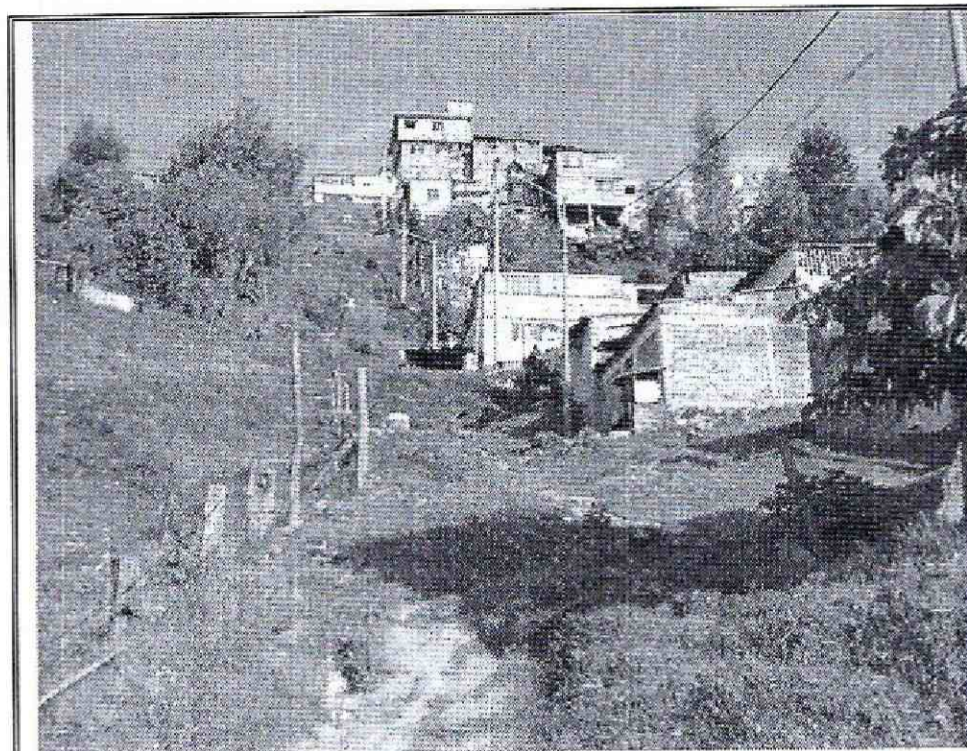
Vía de acceso a la vivienda de la Calle 1A Bis No. 5 -43 Este. Barrio El Dorado - Localidad de Santa Fe.
